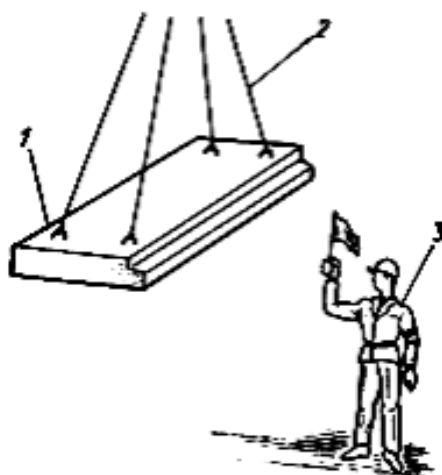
Схема подъема площадки 1- площадка, 2 -универсальное грузозахватное устройство, 3- рабочий, выполняющий такелажные работы.
